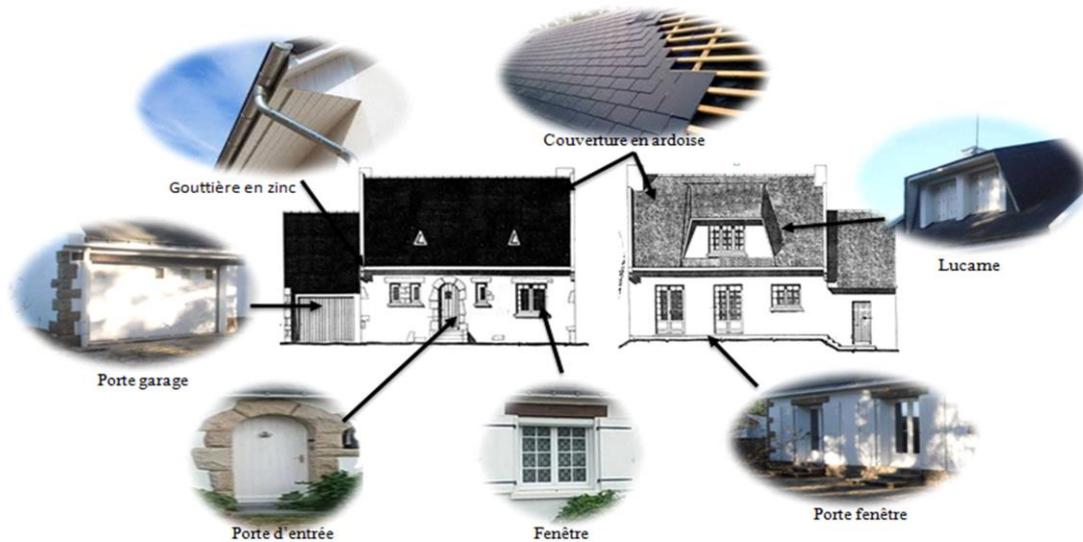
schéma représente les matériaux de construction de le pavillon breton.
